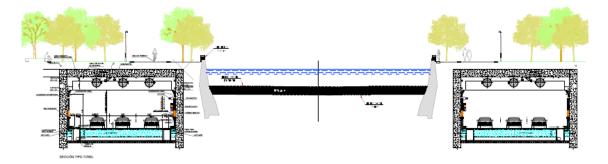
tunnel M30 Rio - section à 2x3 voies longeant la rivière
